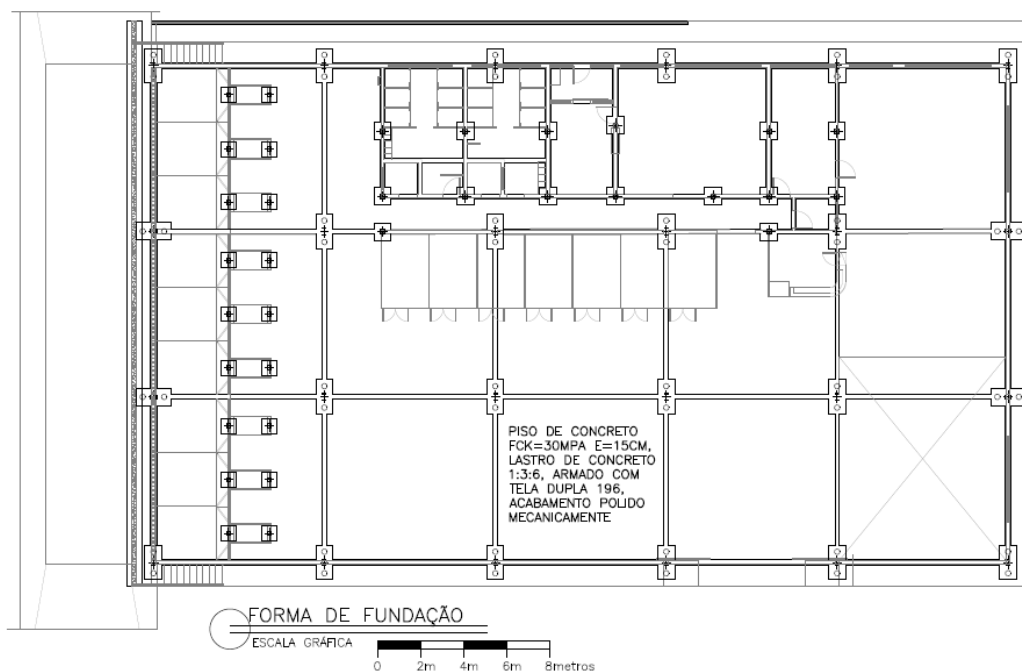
Projeto Estrutural - Forma de Fundação e especificação do piso.
